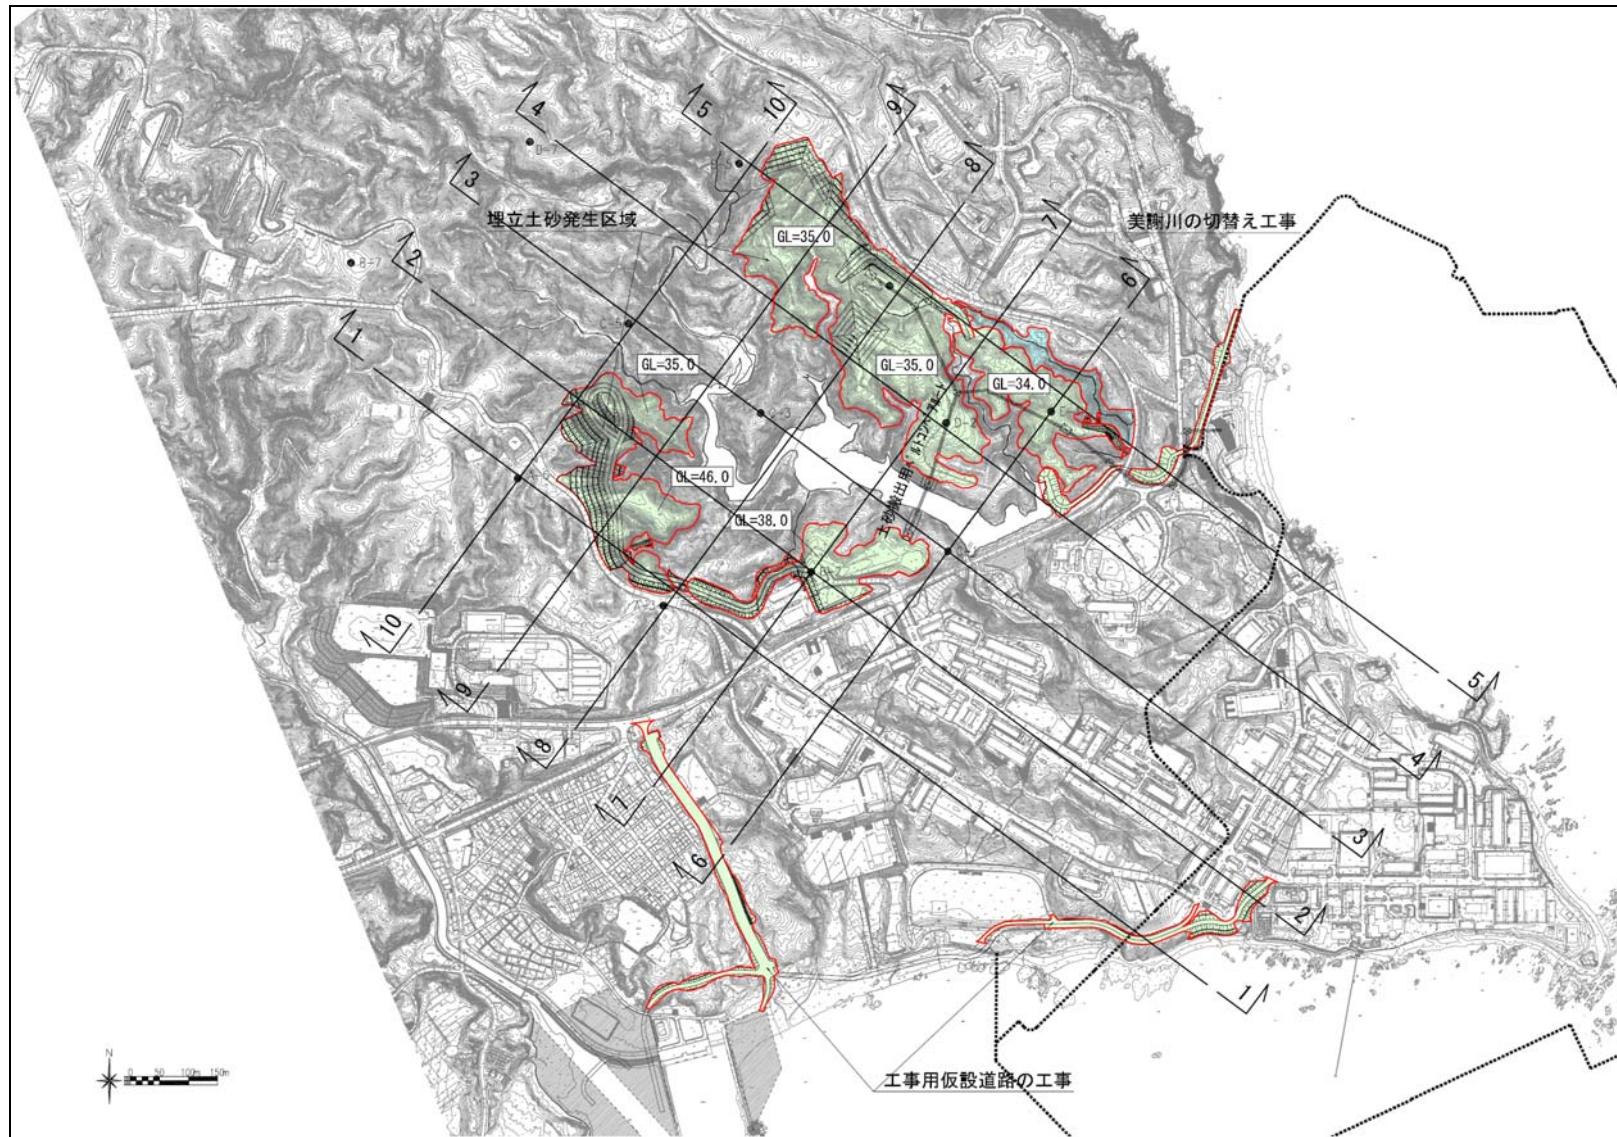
陸上工事に係る改変区域（埋立土砂発生区域、工事用仮設道路、美謝川の切替え）平面図
